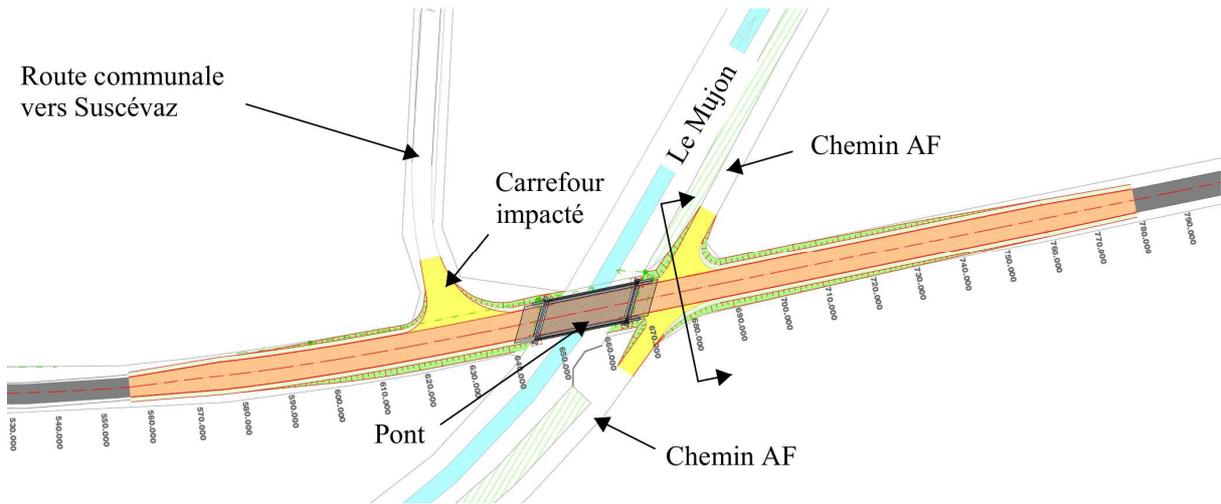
Situation pont sur le Muijon avec rampes d'accès
